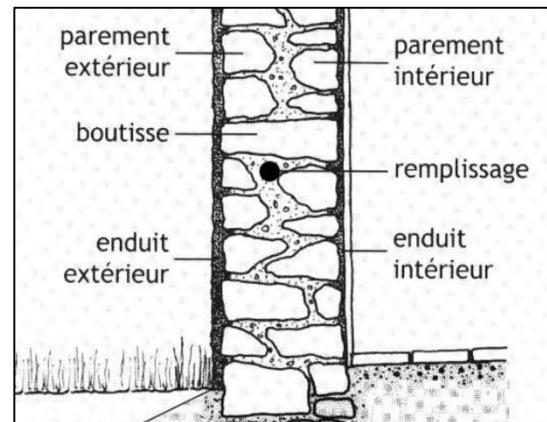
Détail schématique des matériaux composant les parois extérieures en pierre (<https://blog-patrimoine-facades.com/murs-murs/>).
